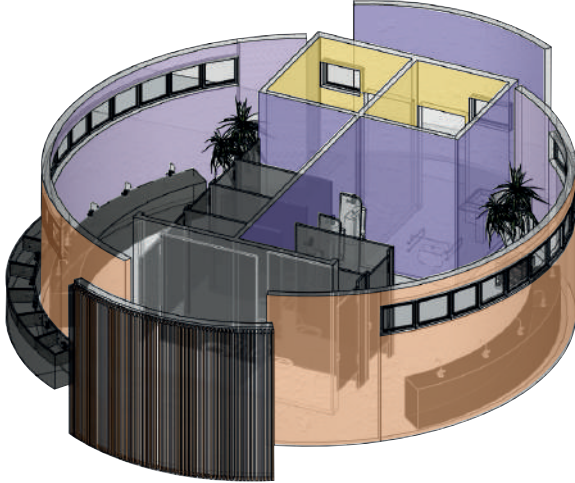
Detalle constructivo paredes con aislamiento y revestimiento de pintura natural
